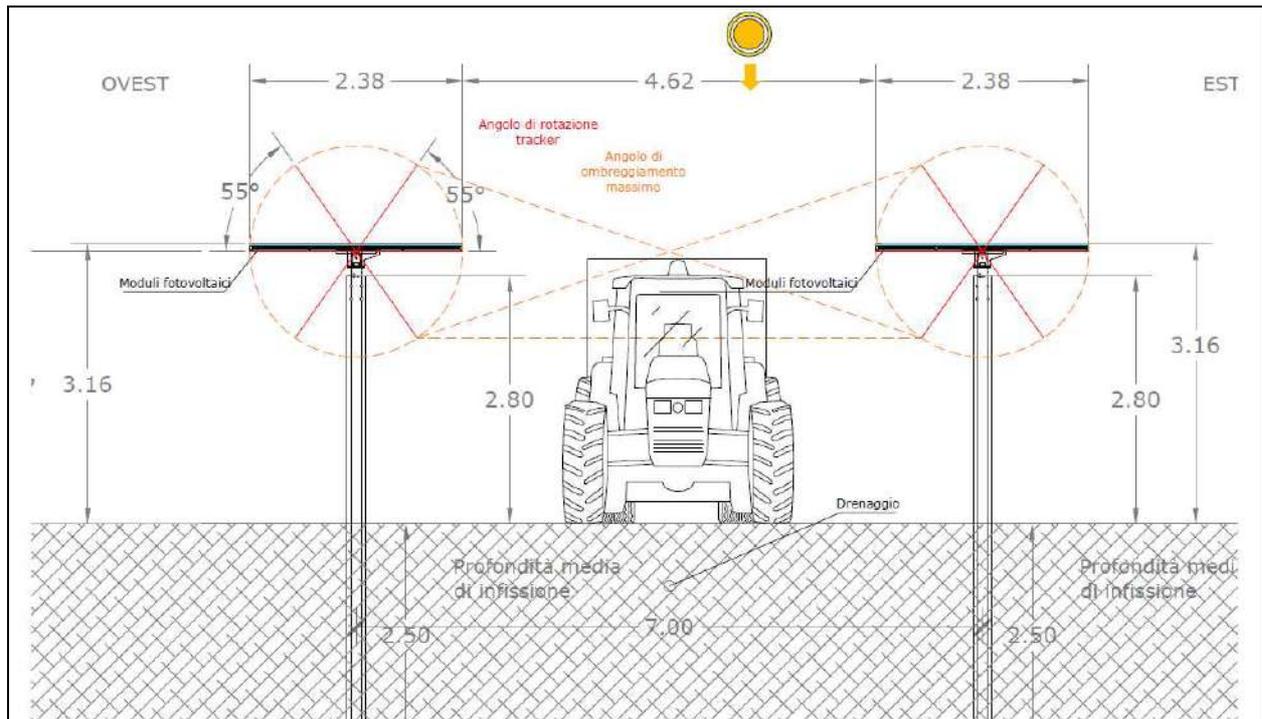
Sezione di dettaglio posa pannelli - posizione orizzontale - max ingombro planimetrico (stralcio da Tavola T12)
